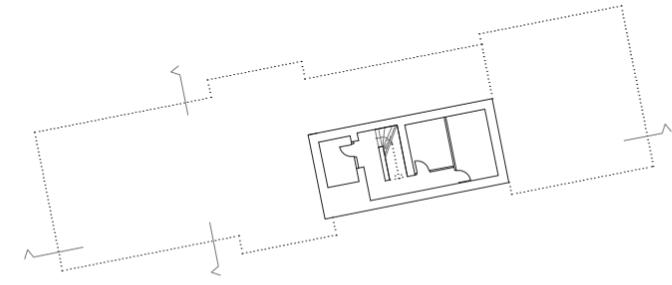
| BESTANDSGEBÄUDE JUDENBURG
